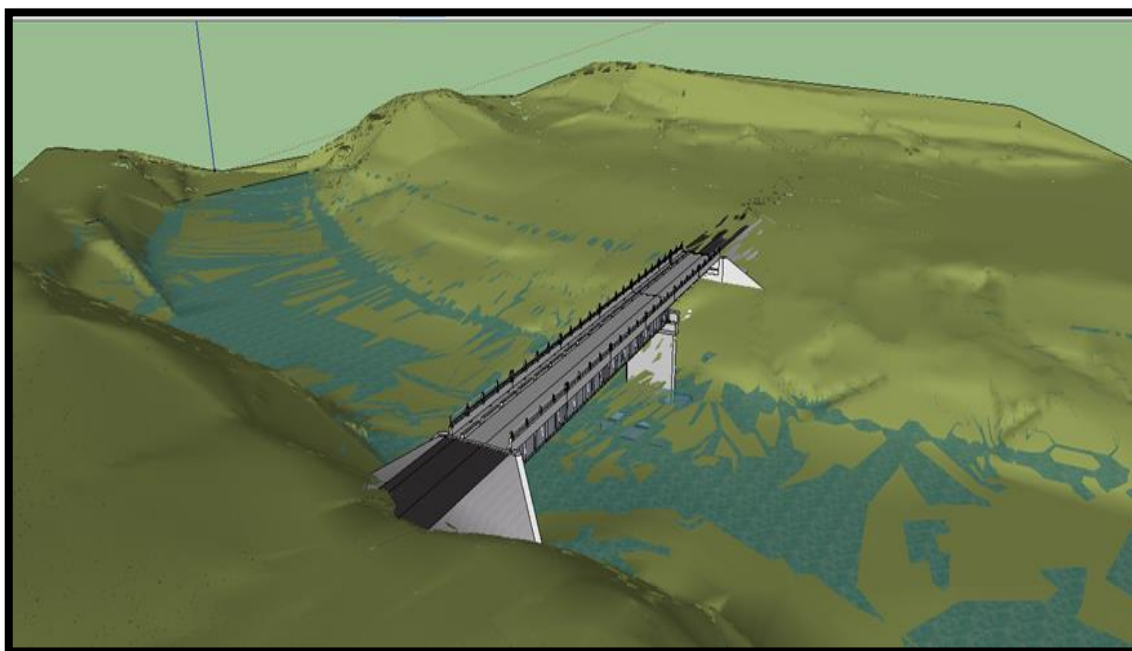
Puente el Tigre, vista completa de los 2 estribos y la pila
